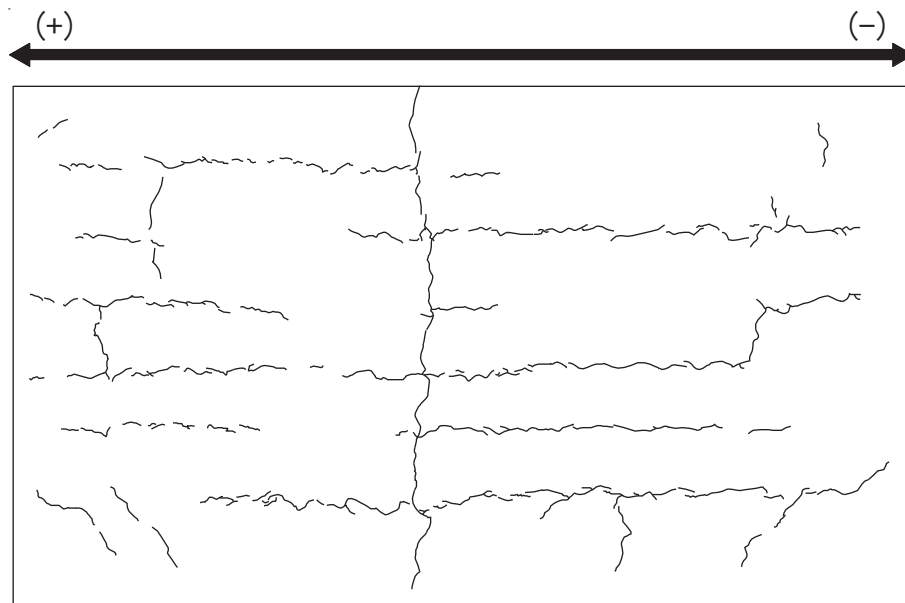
(1) 乾燥試験体 [1] 加力前におけるひび割れ図
